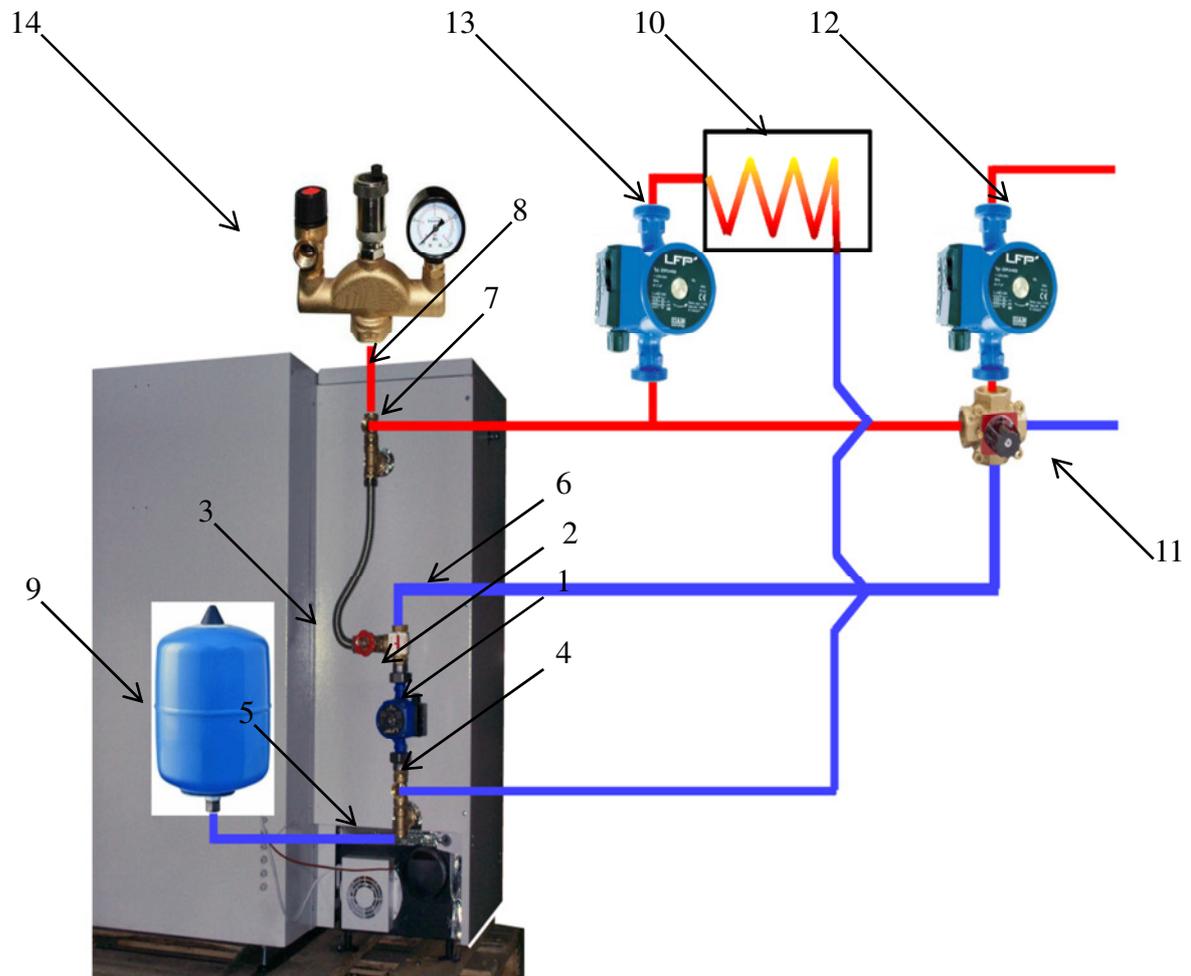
Beschreibung des hydraulischen Kit mit Thermostatventil, Installation im geschlossenen System mit Ausdehnungsgefäß:
